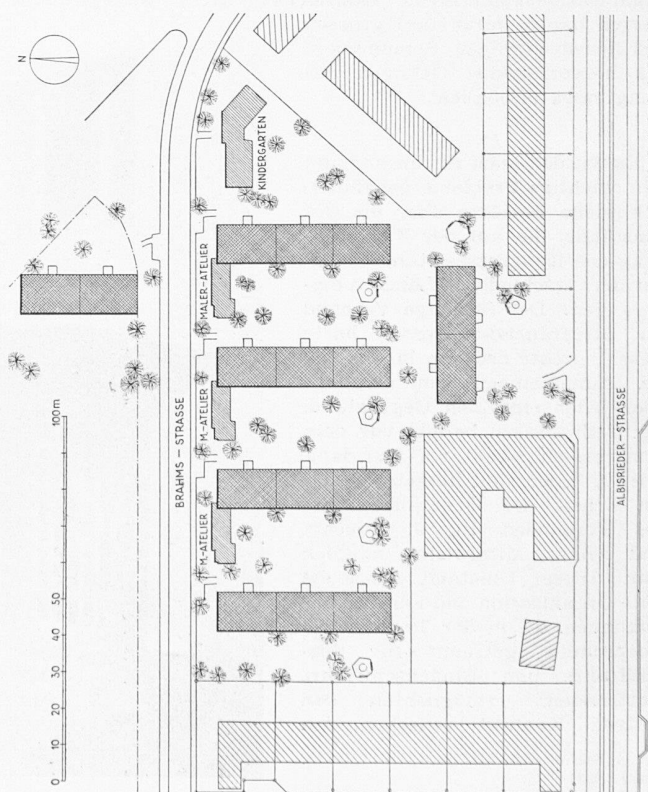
Siedlung Heiligfeld I, Lageplan 1:2000
